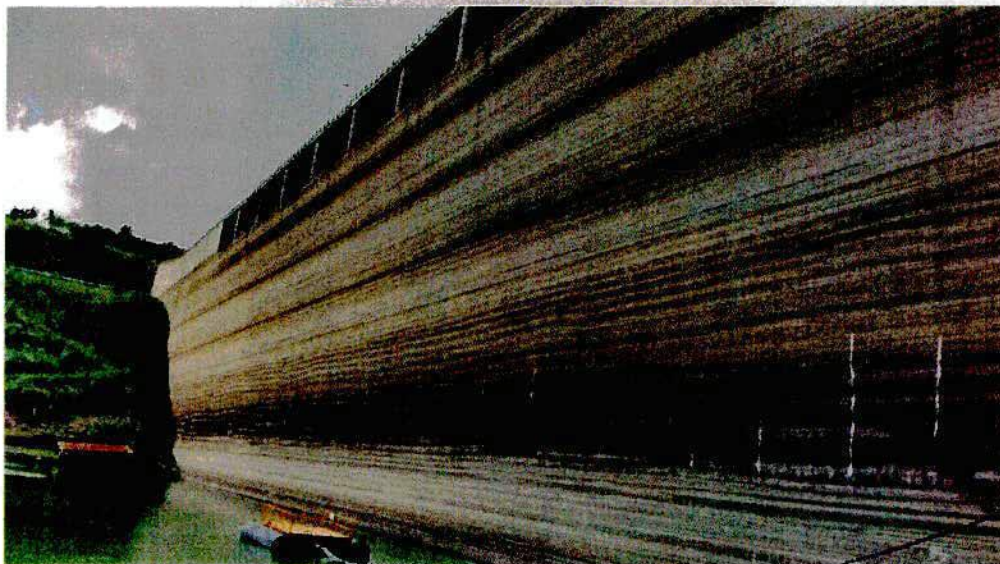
Foto sugere presença de fissura e ondulações horizontais ao longo da barragem em montante (20/04/16).
